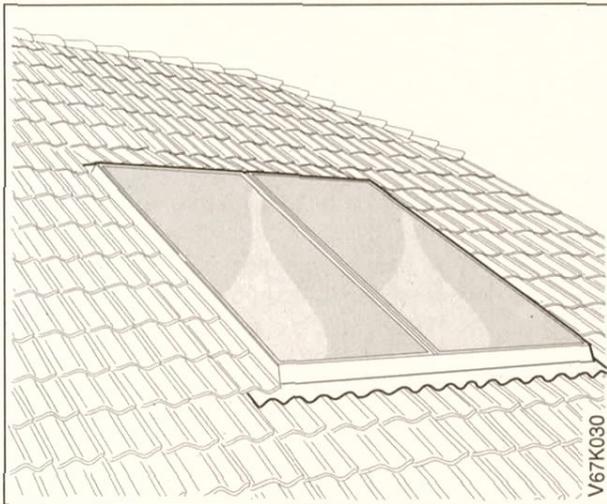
Zum Schluss Bleischürze an Ziegel anpassen. So sind die Kollektoren ansprechend ins Dach eingebunden.
